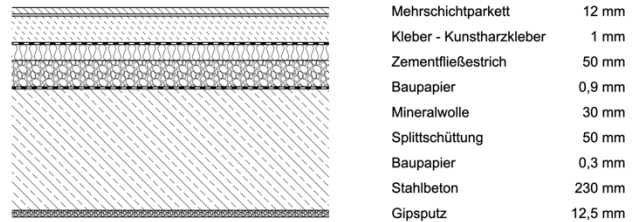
Detail Deckenaufbau Stahlbetondecke (maßstabslos)
